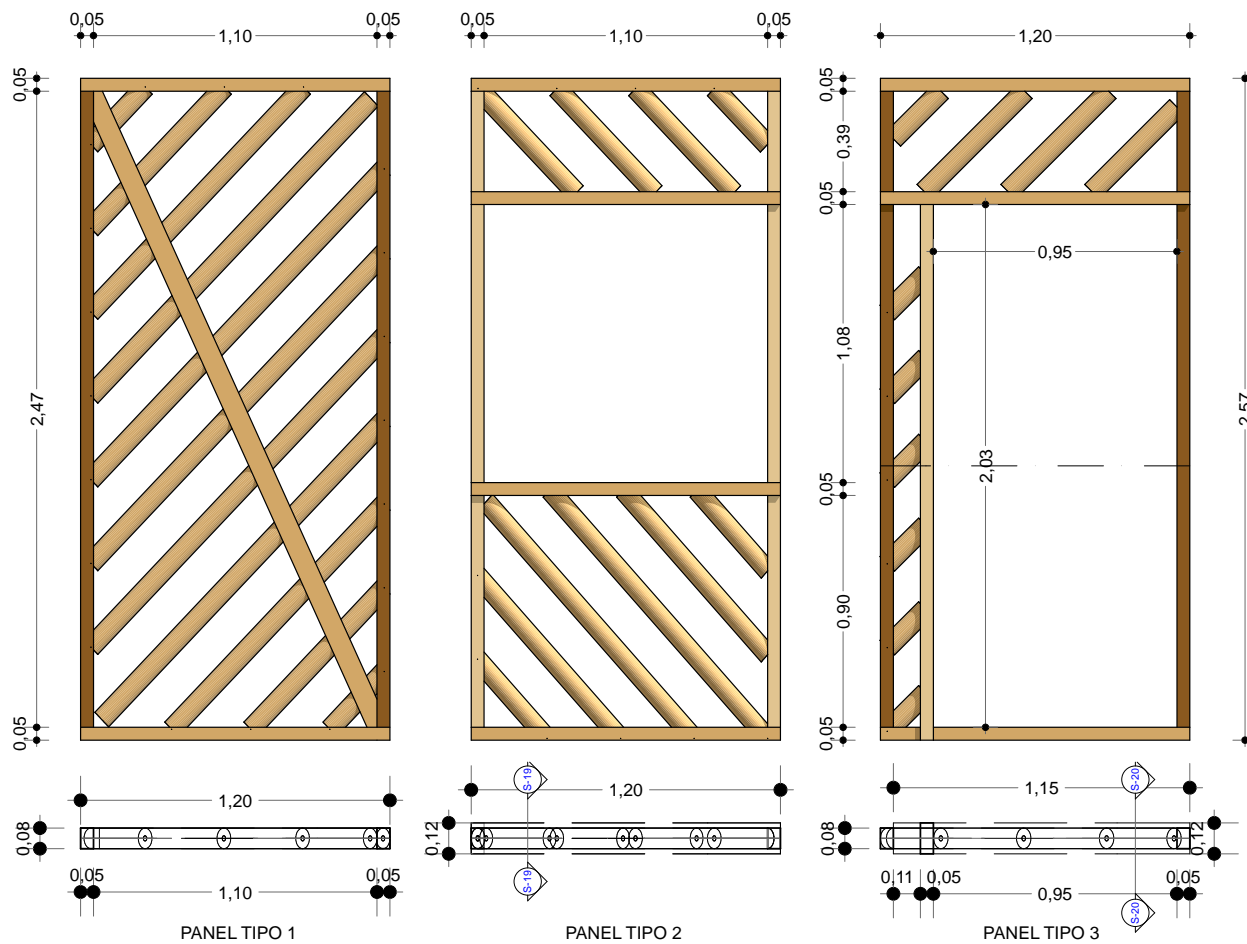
PLANTA Y ELEVACION DE PANELES PROPUESTOS
